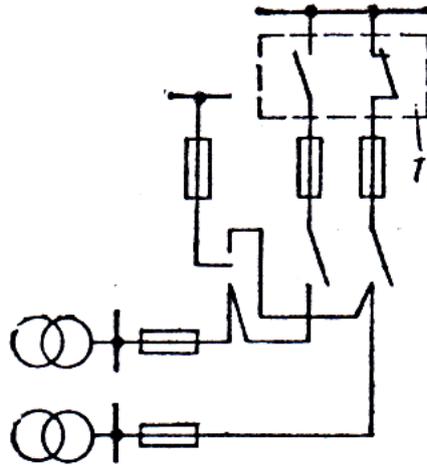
Схема электроснабжения жилого дома высотой 17 этажей и выше
